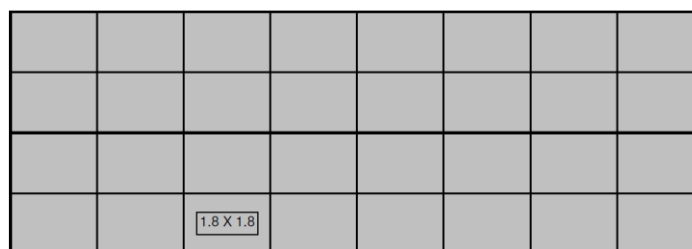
Pavimento de concreto con losas cortas. Fuente: M. Becerra Salas, Tópicos de Pavimentos de Concreto, Lima-Perú: Flujo libre, 2012
